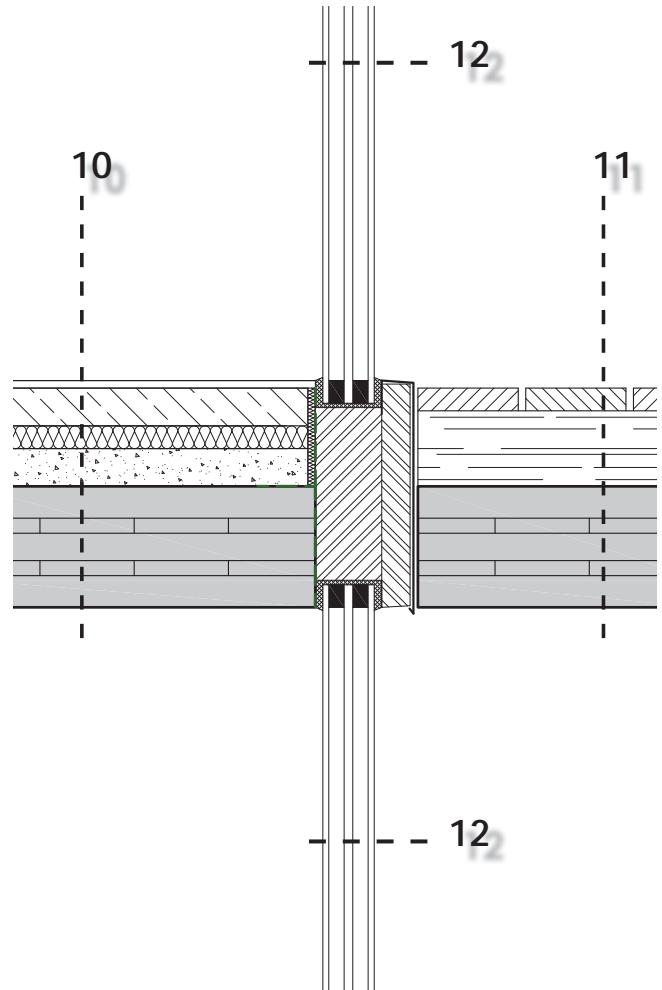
Anschluss Trenndecke an Balkon - M 1:10
